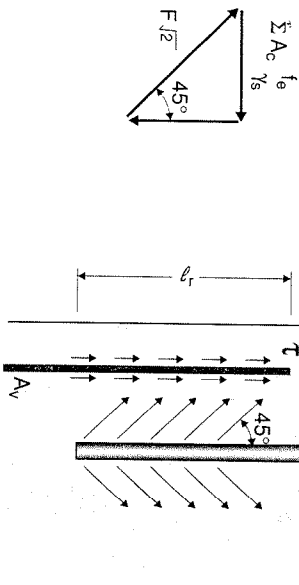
Entraînement des armatures par les tiges d'ancrage.
